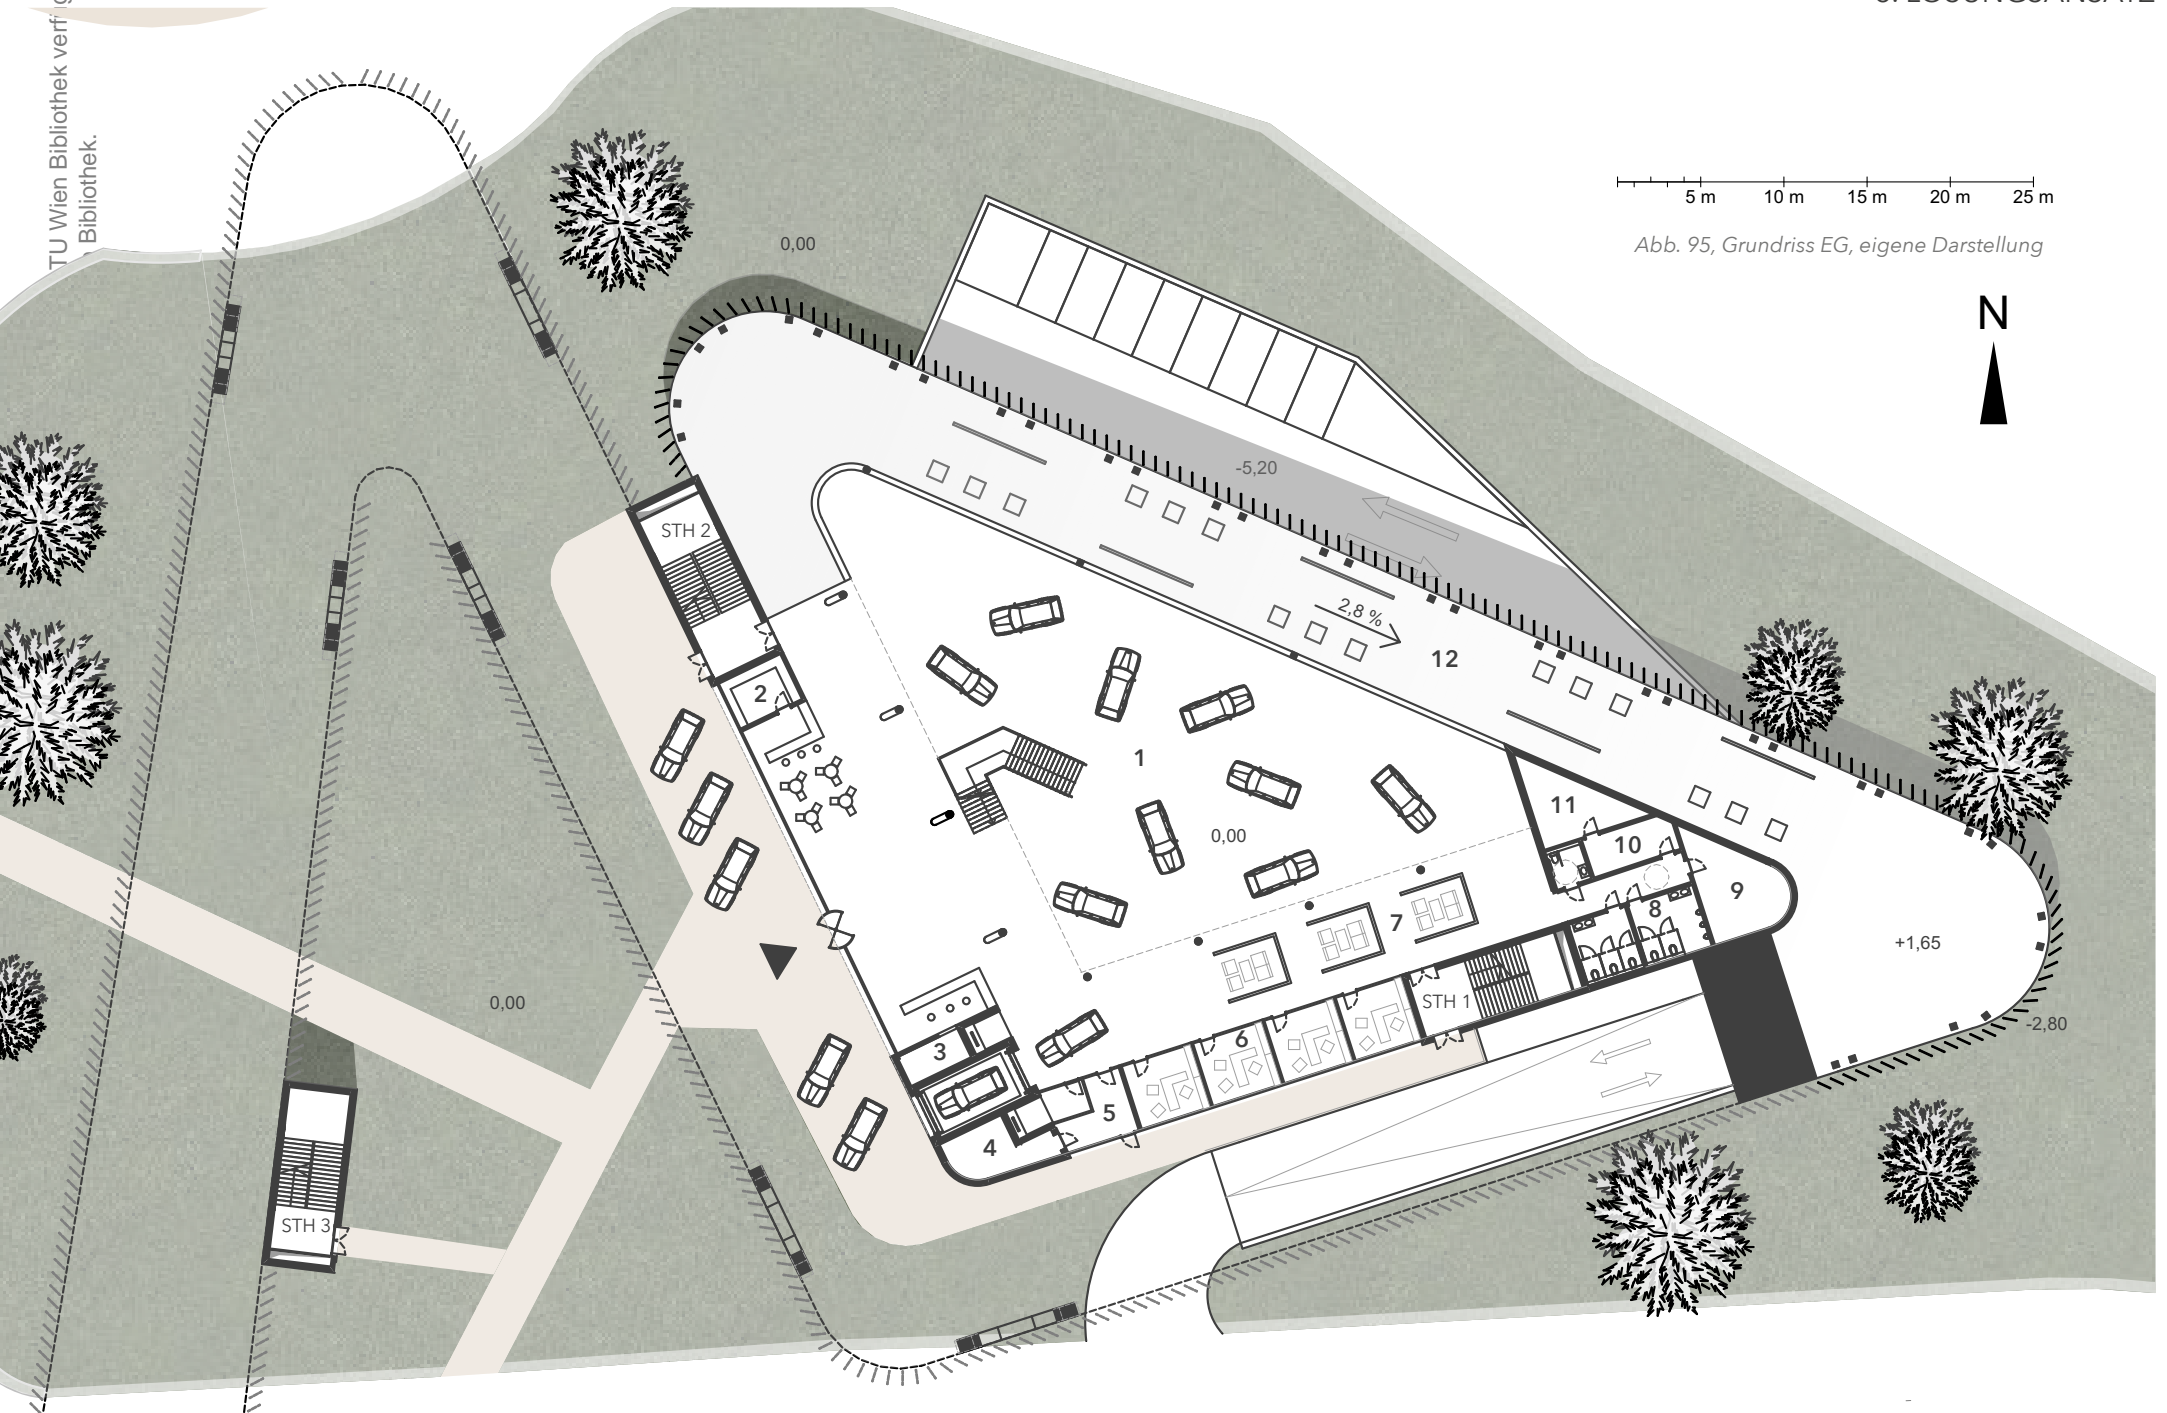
, Grundriss EG, eigene Darstellung
